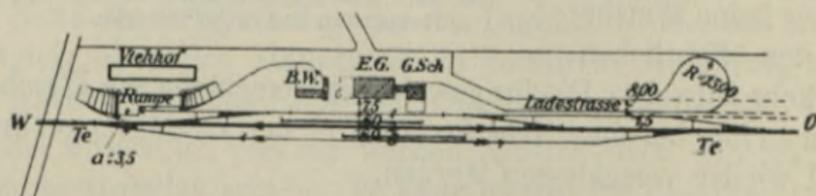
Bahnhof einer Nebenbahn mit einseitiger Ladestraße mit Kreuzungs- und Überholungsgleis (Lageplan). M. 1 : 6000.
